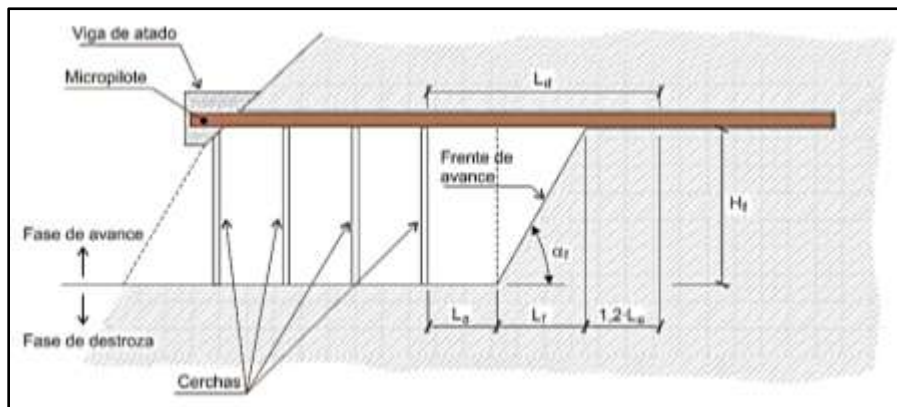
Longitud de cálculo de las vigas  $L_d$ . Fuente: (Minería, 2011)
